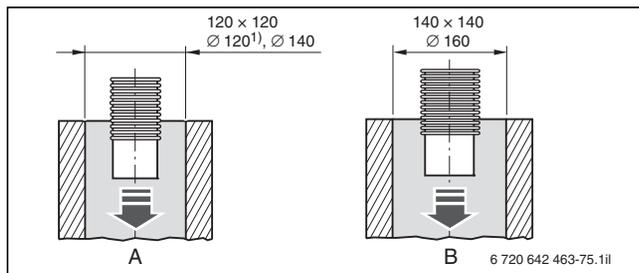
Mindestmaße des Schachtquerschnitts für die Montage der flexiblen Abgasleitung (Maße in mm)
